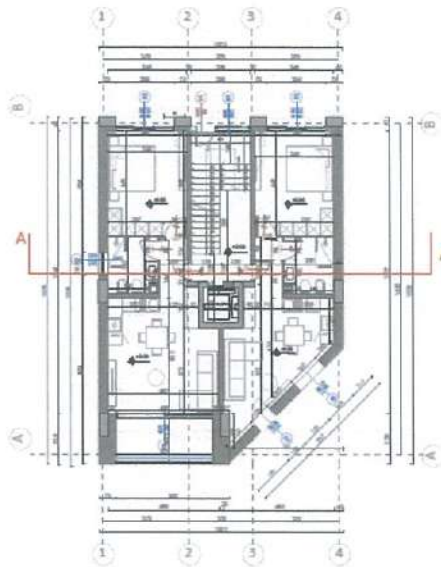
Planimetria e katit përdhe, Objekti 9, Prona Veriore
